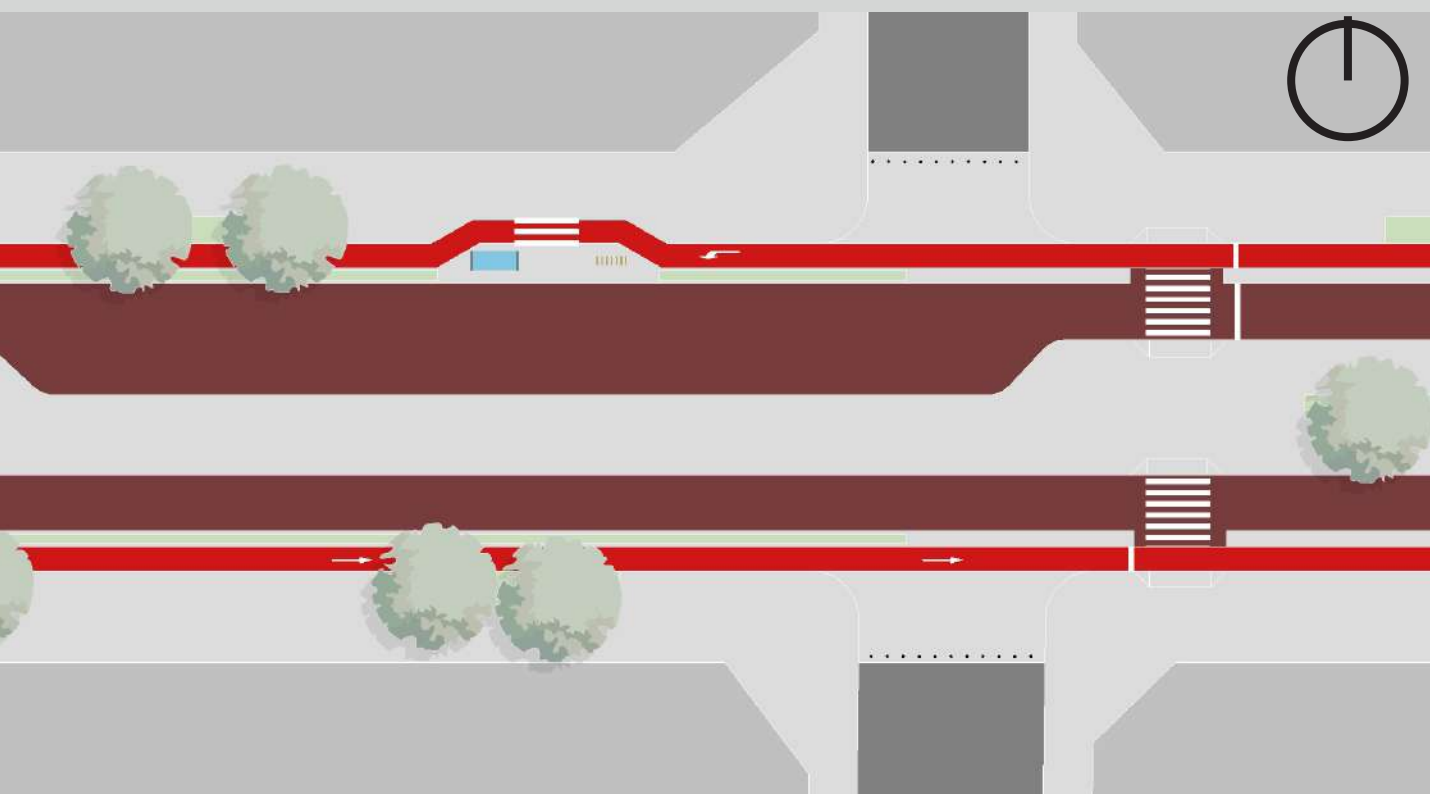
Trecho da Avenida T-63 localizado no Bairro Anhanguera após a proposta. Escala 1:500.
